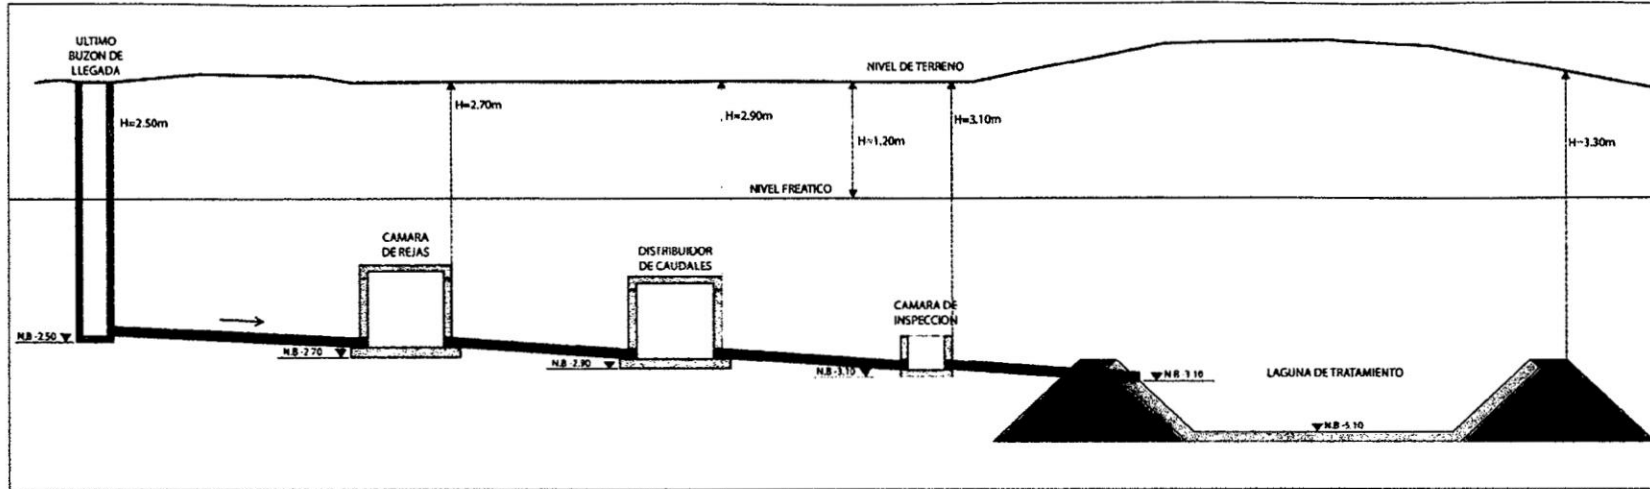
Planteamiento de problema del proyecto de tipo convencional. Fuente: Elaboración propia
